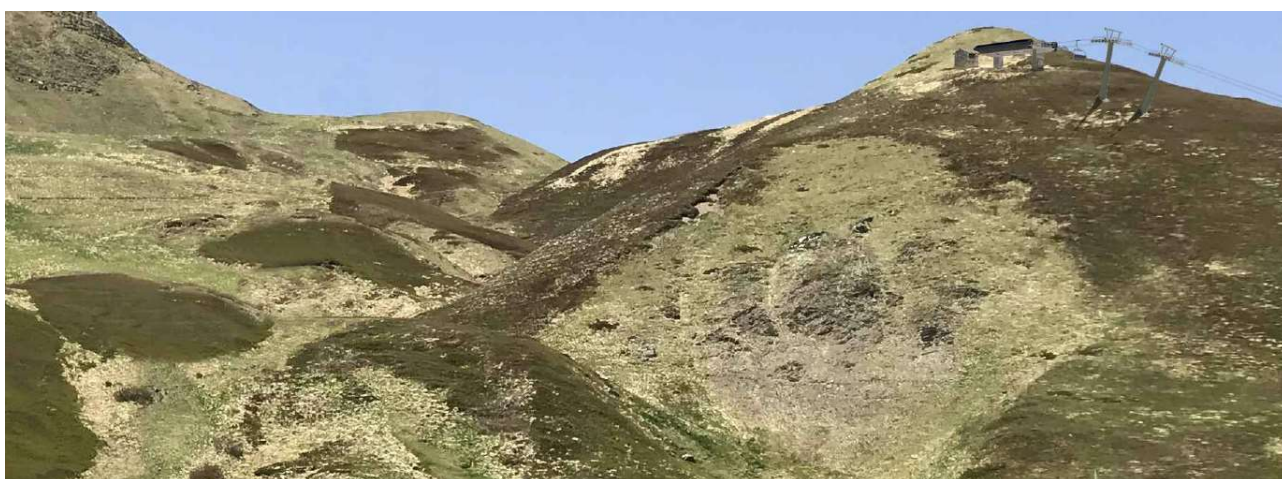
Stazione di monte – Stato futuro – Vista 4
